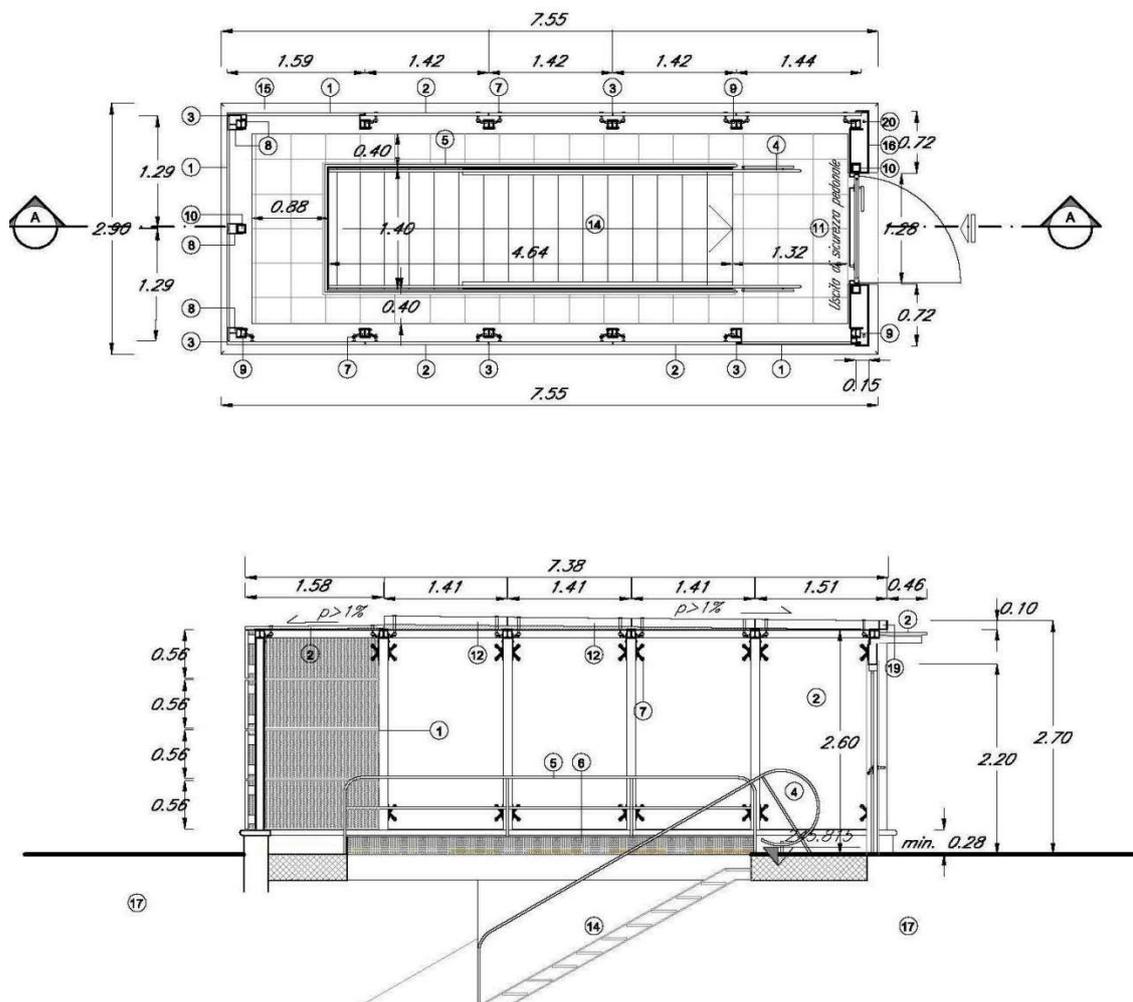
Tipologico A: torino a copertura di singola rampa di scale: pianta e sezione longitudinale
